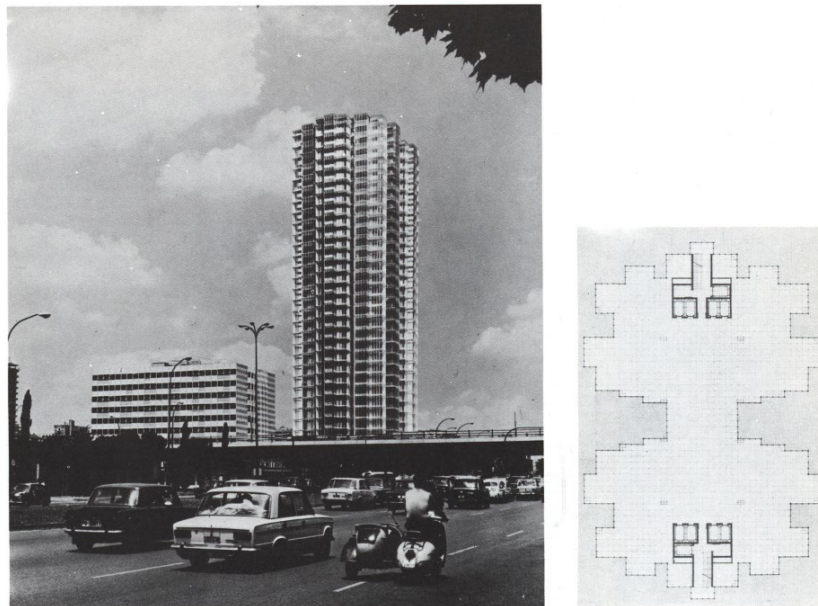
Propuesta Banco Bilbao. Fotomontaje y planta. Fuente: Capitel 1981, 12
